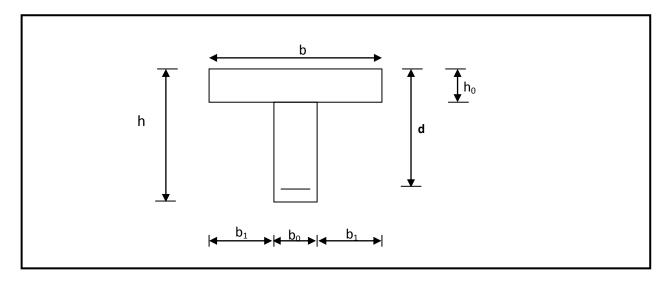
Section de calcul de la poutrelle après coulage de la dalle de compression
